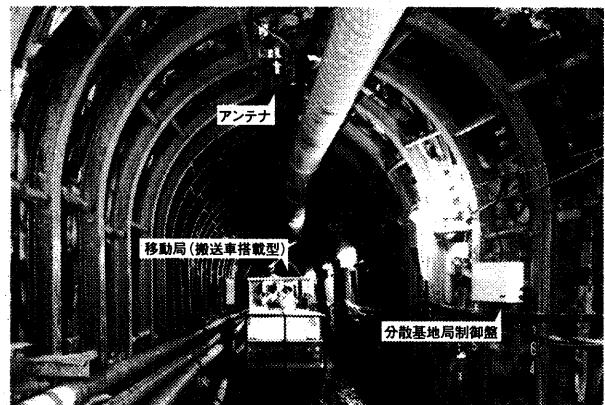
実測トンネル断面 (Measurement Tunnel Section)
